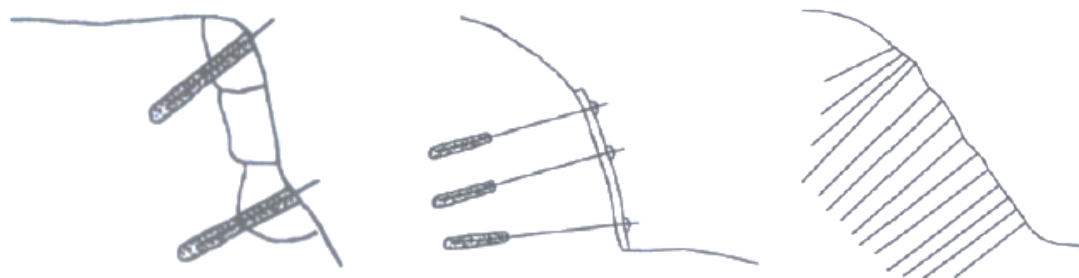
Tipos de estructuras de retención de suelo reforzado. Fuente: ACG (2009)
